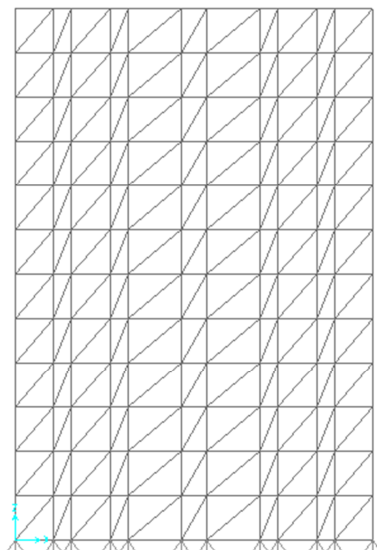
Configuração dos Planos de Contraventamento Vertical Com Elementos de Contraventamento Pequenos
